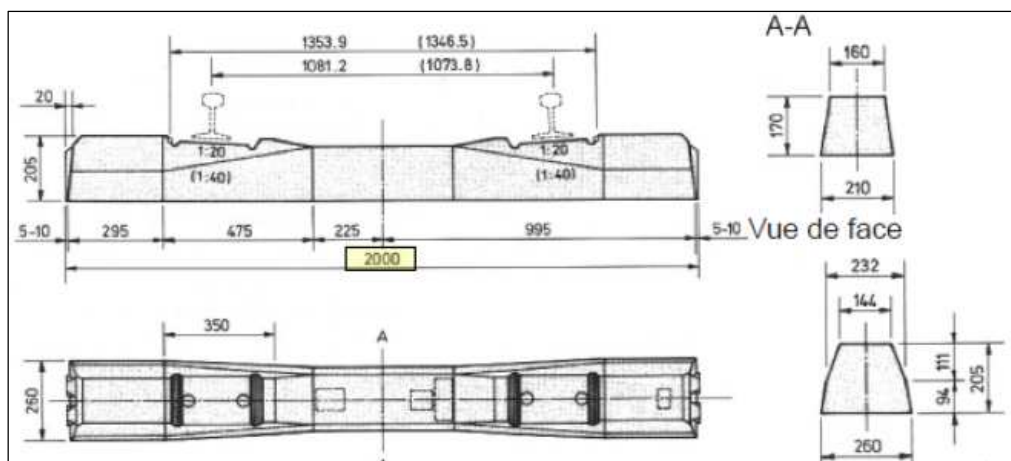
Traverses béton monobloc VöV-E M2 pour voie adhérence
